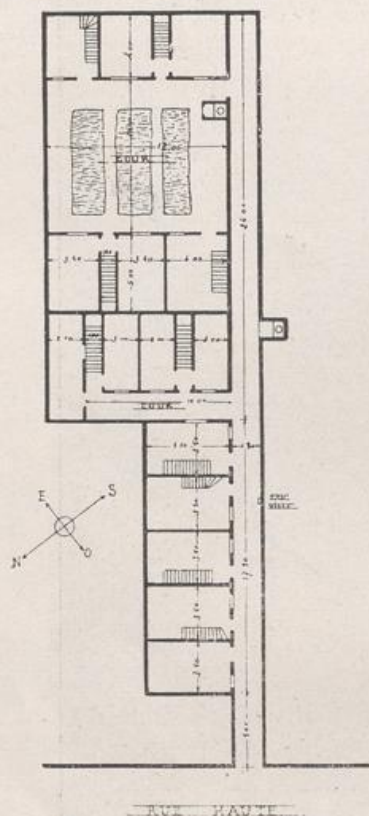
Warschauer Gang, Grundriß¹⁾.
